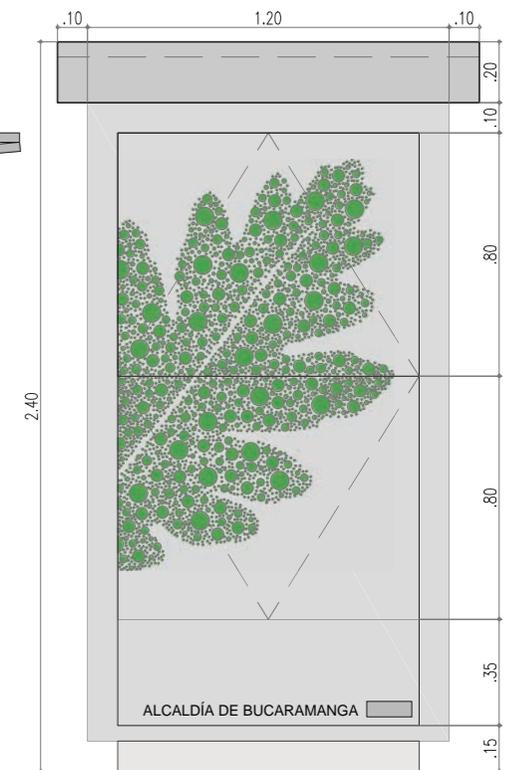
Fachada puesto de venta estacionario tipo 2. Esc 1:25
